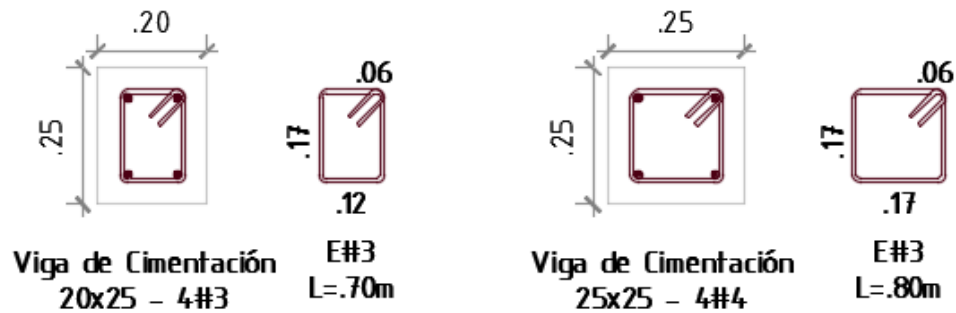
Detalle de refuerzo de vigas de cimentación (a nivel de terreno)
